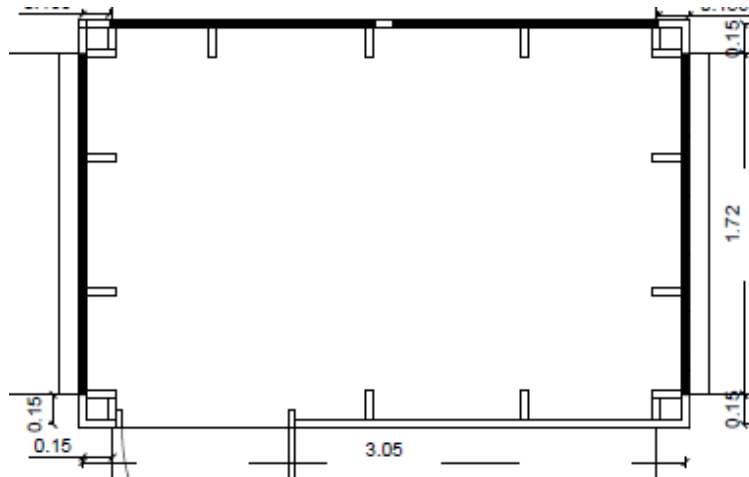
Planta constructiva cocineta para Parque Cusuco, Cortés (m)
